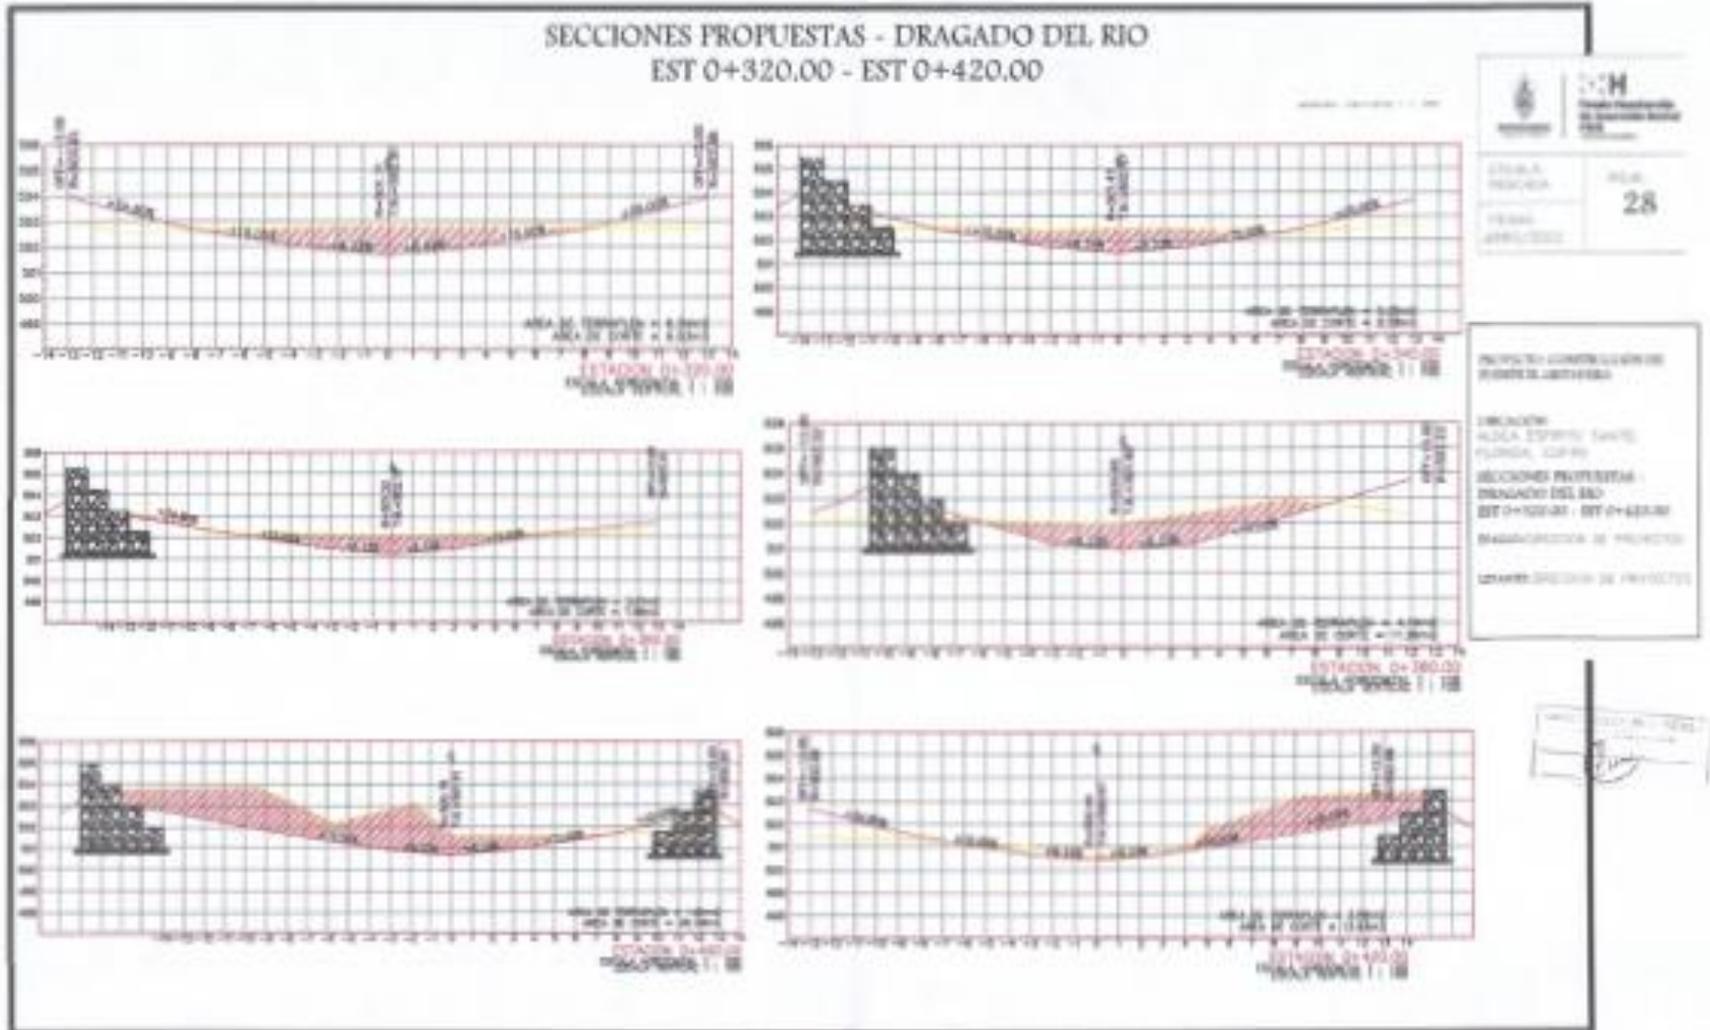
Secciones propuestas para dragado de río 0+320- 0+420
